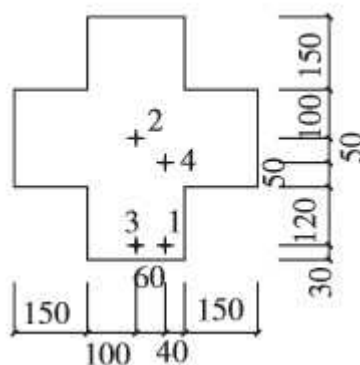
Posição dos termopares instalados no pilar (XU e WU, 2009)
